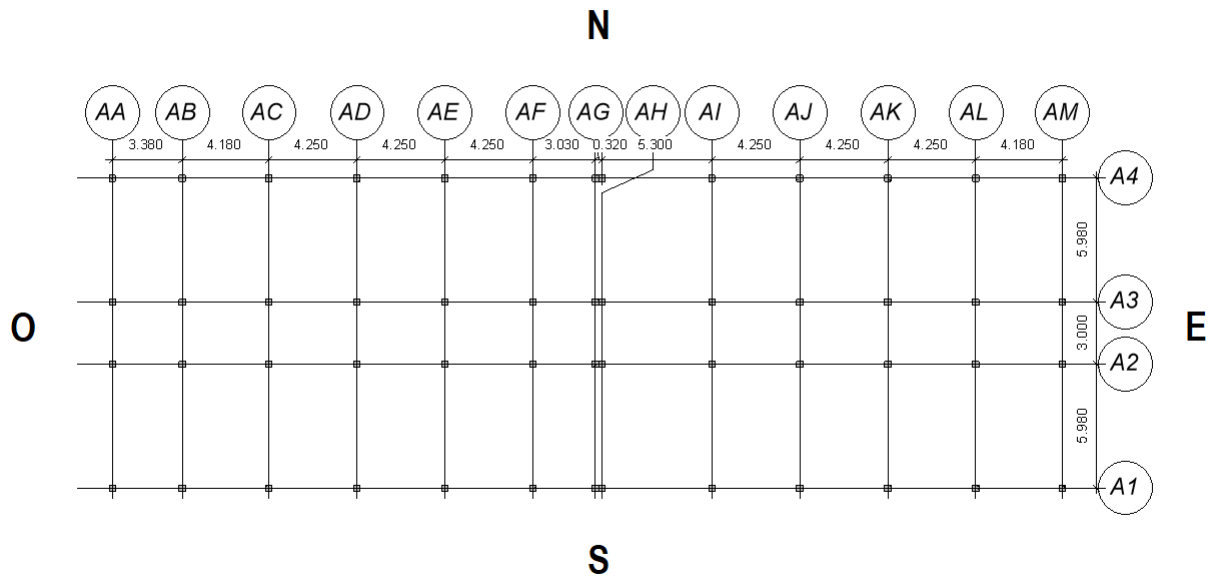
Vista en planta de los pilares del aulario y la distancia entre ellos
